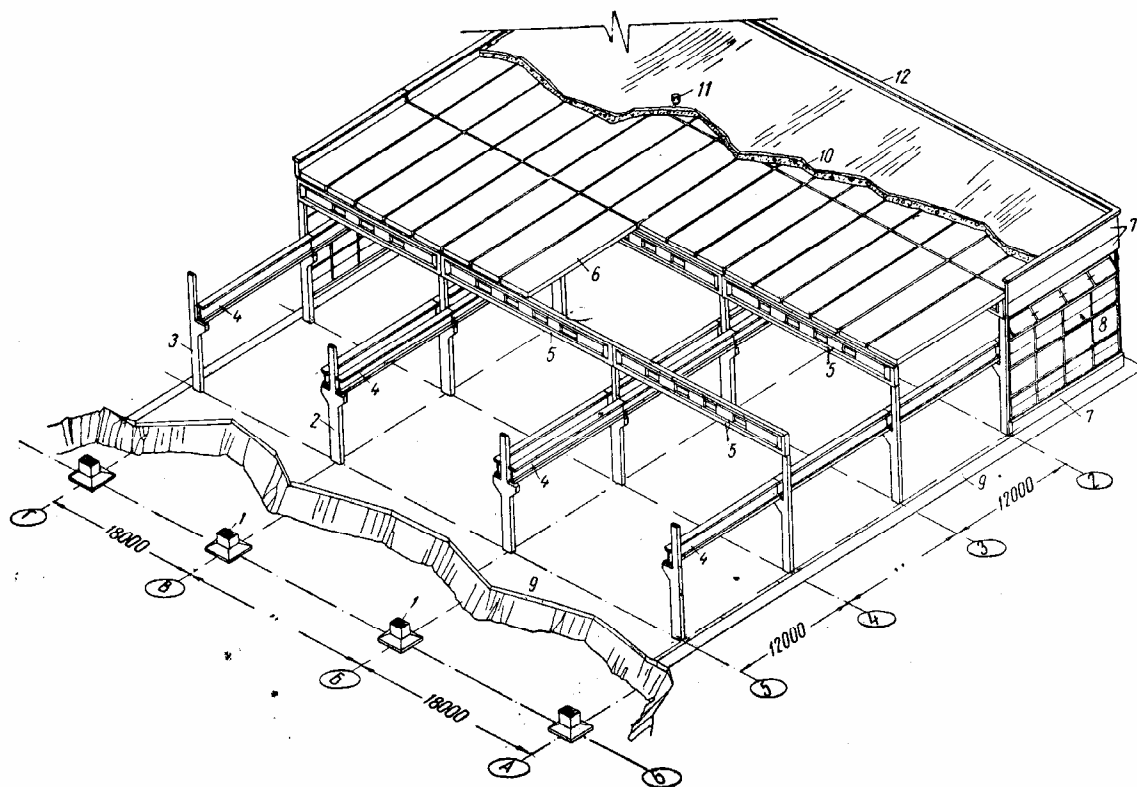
Схема каркаса одноэтажного промышленного здания без подстропильных конструкций
